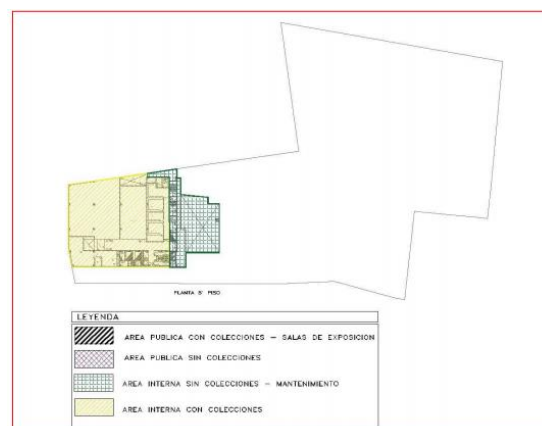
Planta 5to Piso. Fuente: Equipo consultor.
